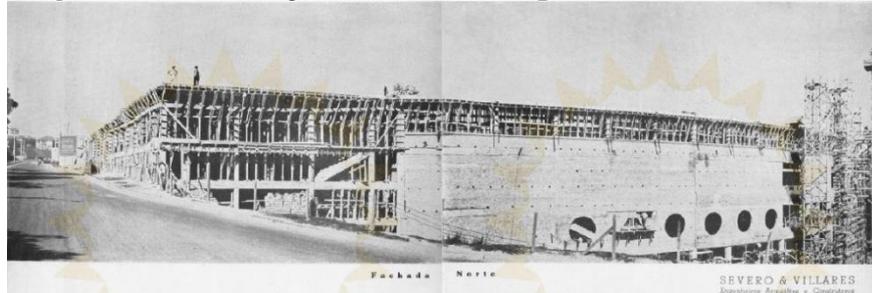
Estádio do Pacaembu – Projeto de Construção Final
